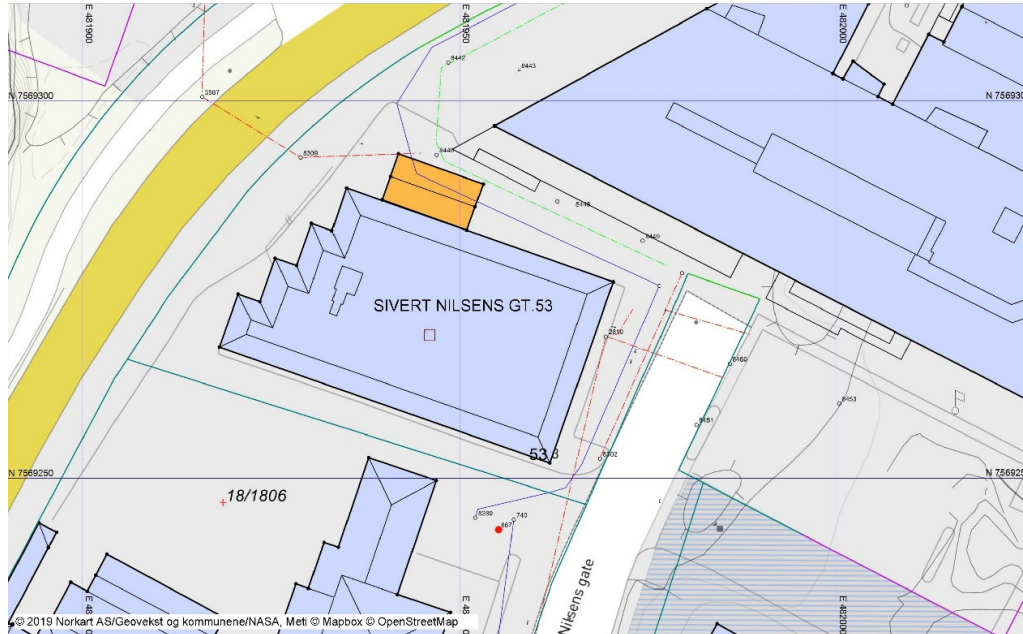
Situasjonsplan. Sivert Nilsens gt.53 midt på planen.
